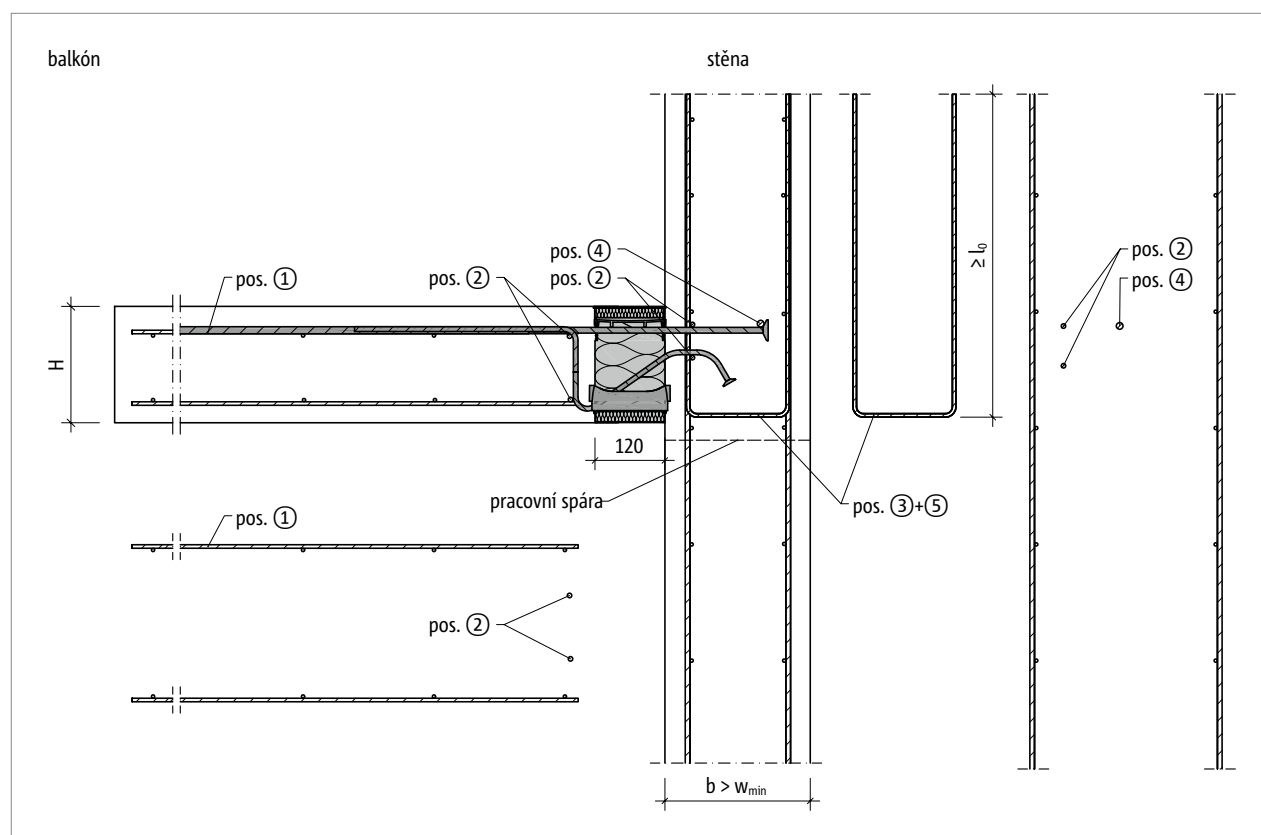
Schöck Isokorb® XT typ KL-U: Napojovací stavební výztuž pro balkón snížený oproti stropní desce – s větším rozměrem ($w_{skut} > w_{min}$)
